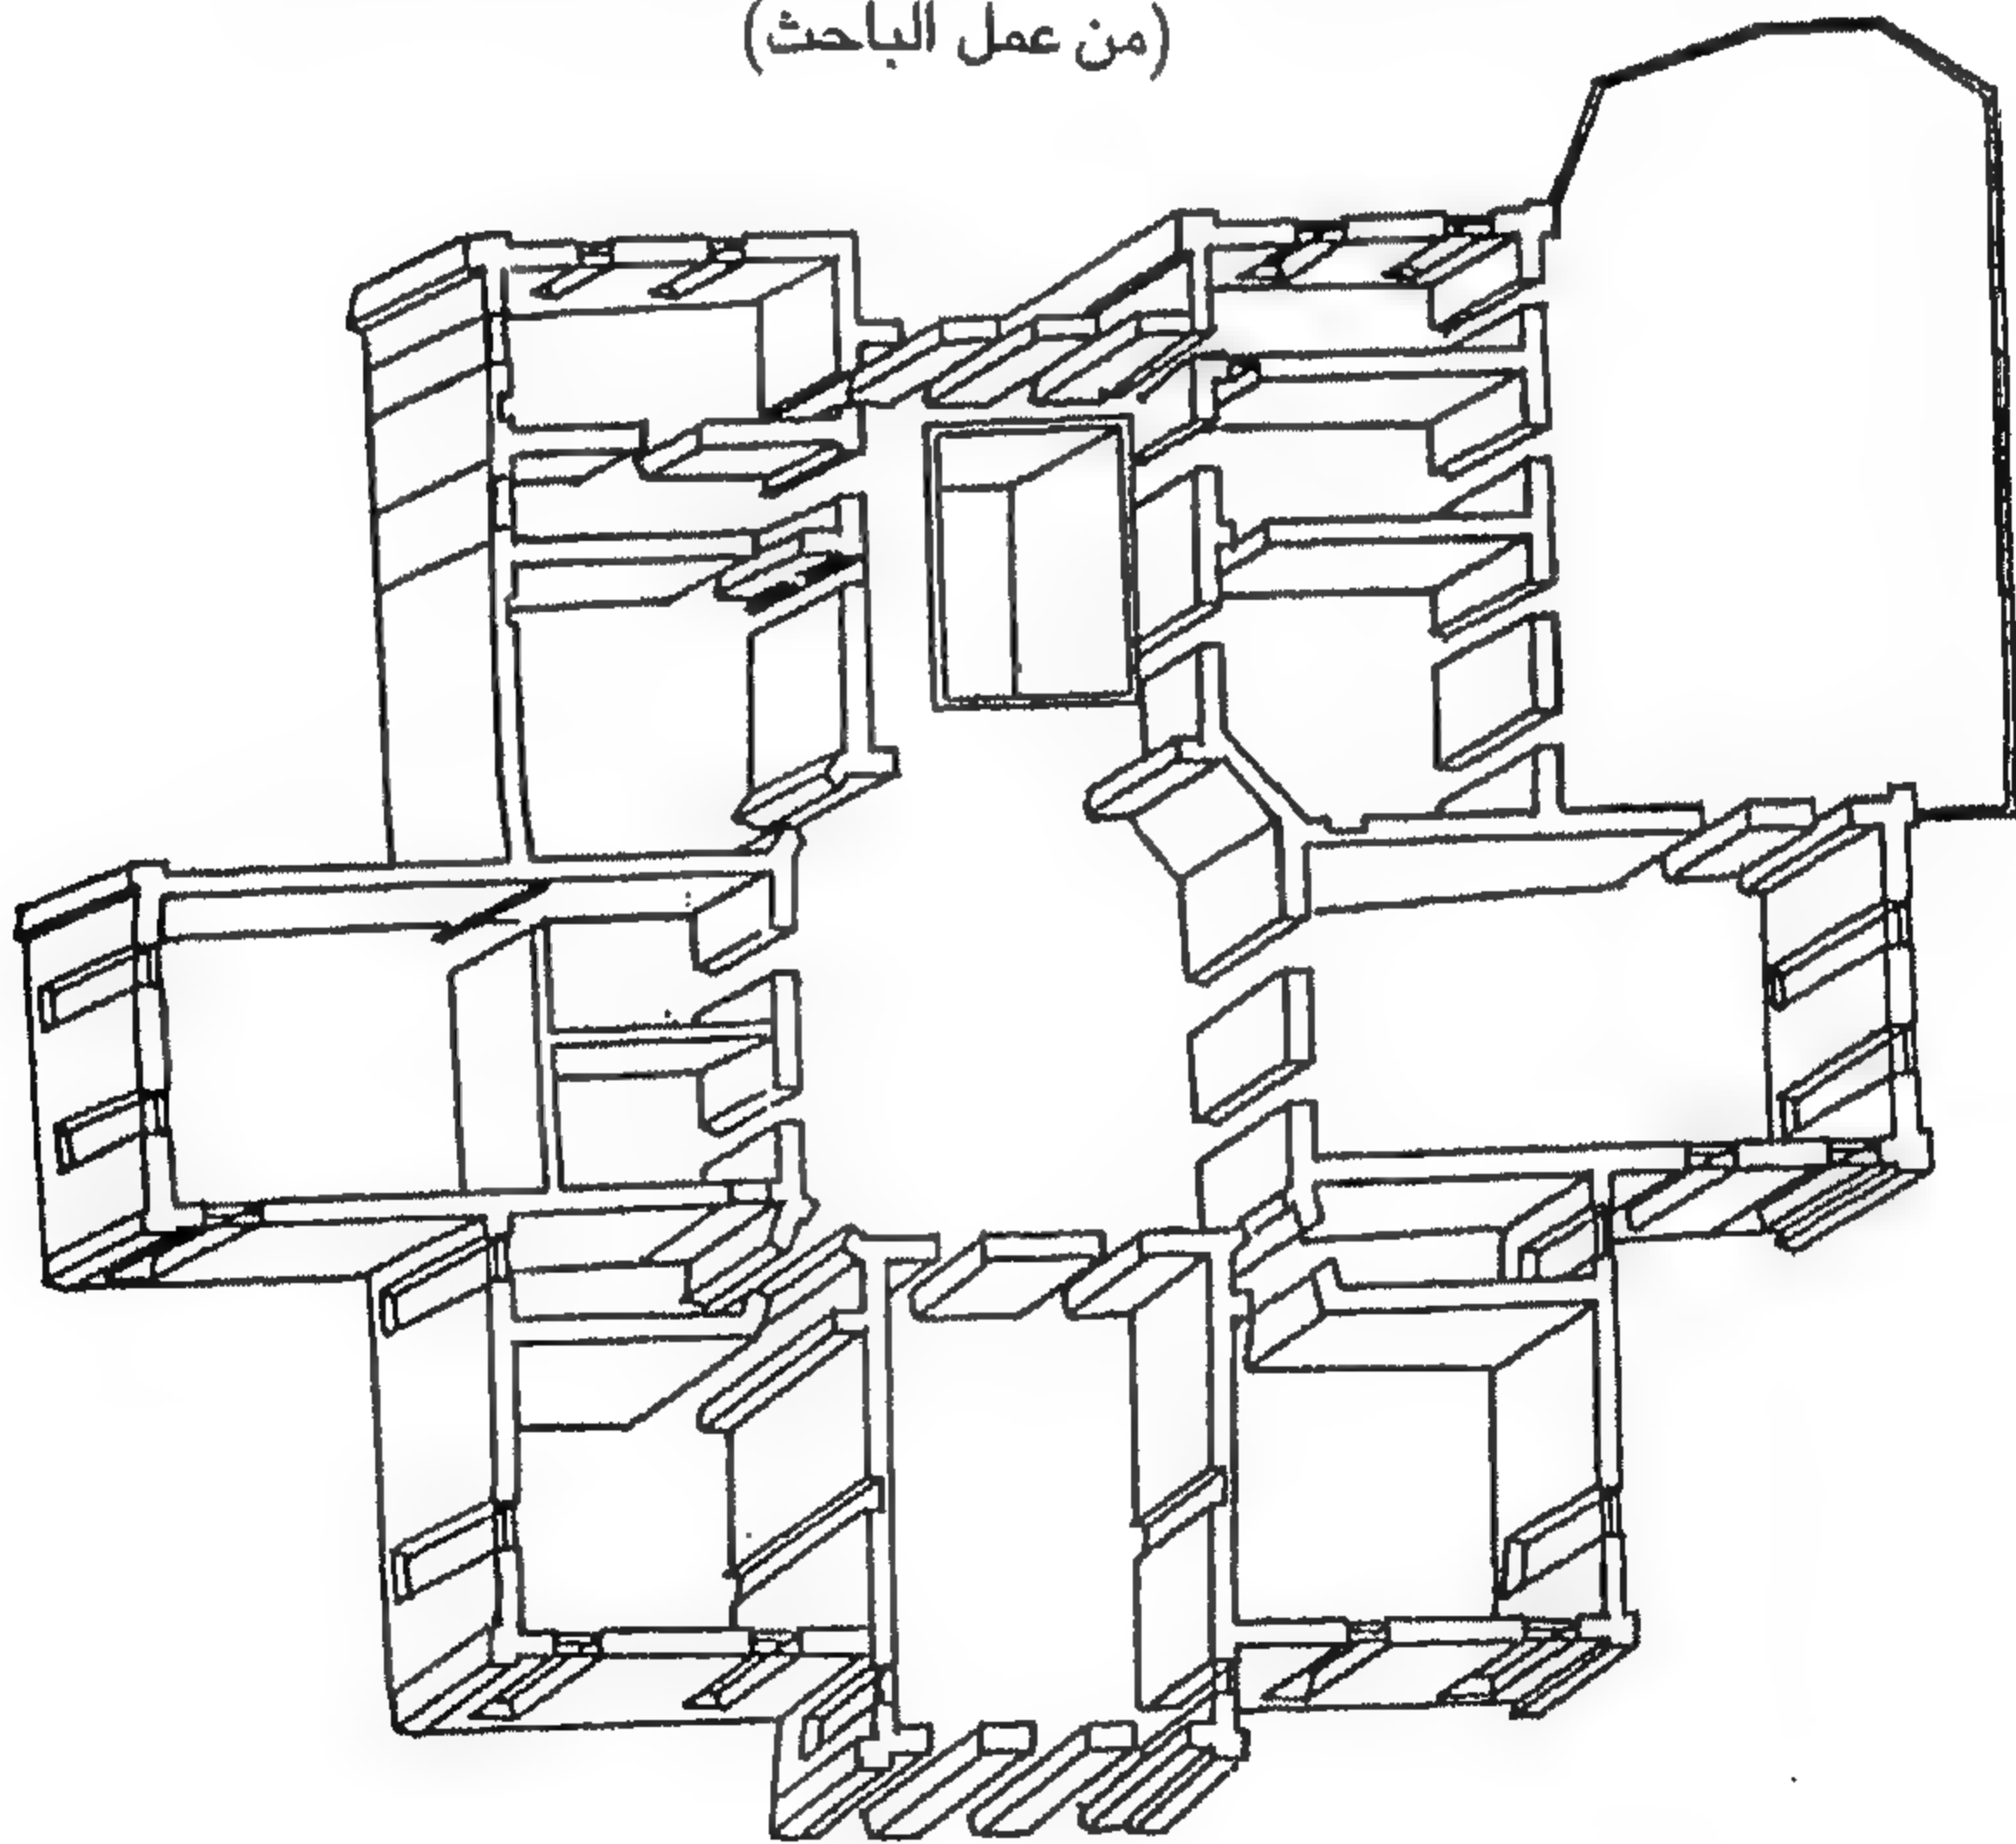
مسقط أفقى للطابق الأول من سراى أمينة هانم زوجة الخديوى
